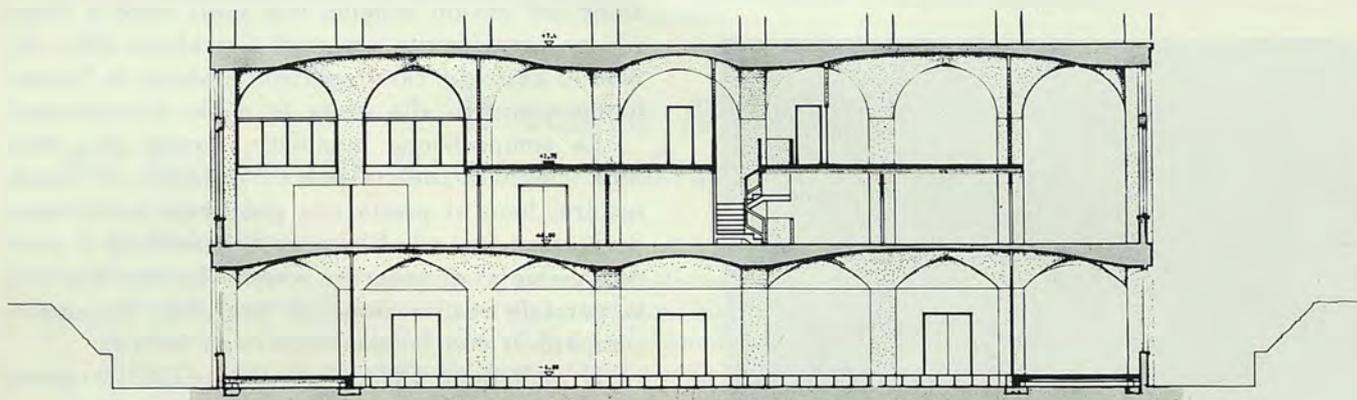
A - Sezione trasversale sulla parte di edificio occupata dal Centro di Calcolo piano ribassato e piano terreno). È indicato l'intervento effettuato per la suddivisione dello spazio interno.
